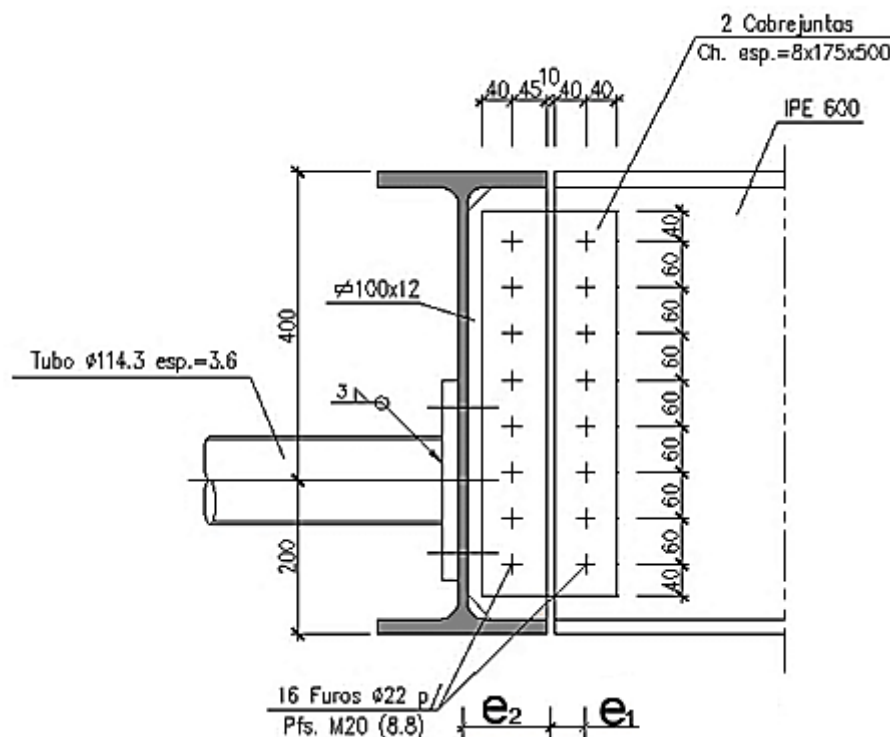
Pormenor construtivo de uma ligação viga-viga articulada, utilizando cobre-juntas e reforços (Cima Gomes; Biscaia, N., 2008)
